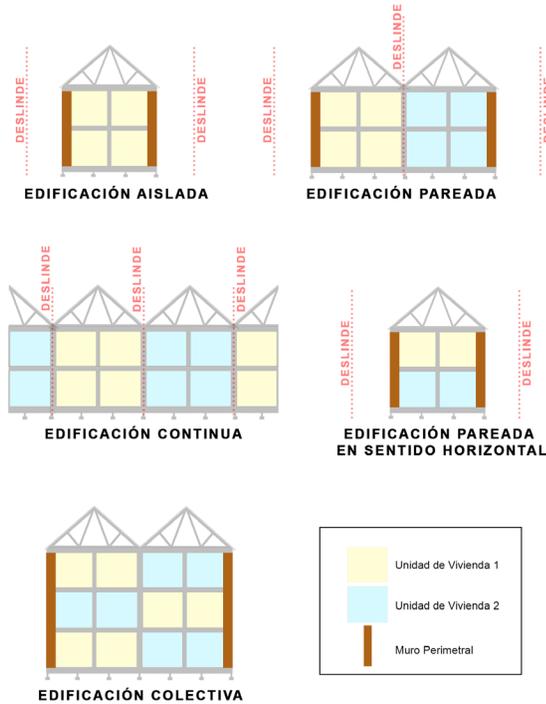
Uso de la solución de Muro Perimetral en las tipologías de viviendas de la OGUC.
